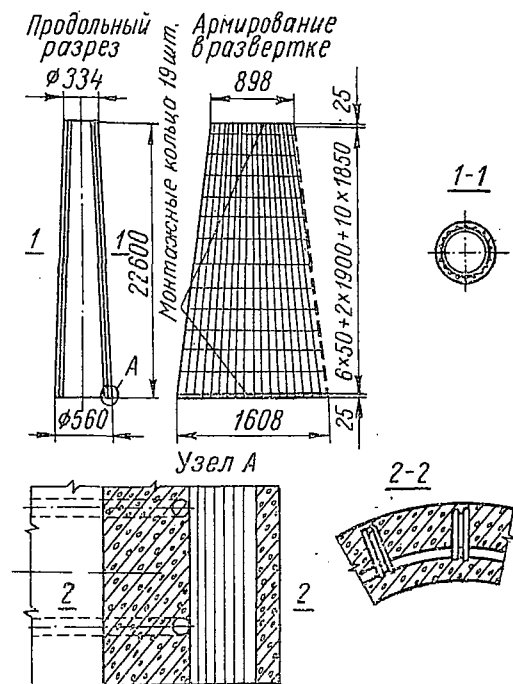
Армирование стойки канатной (прядевой) арматурой
